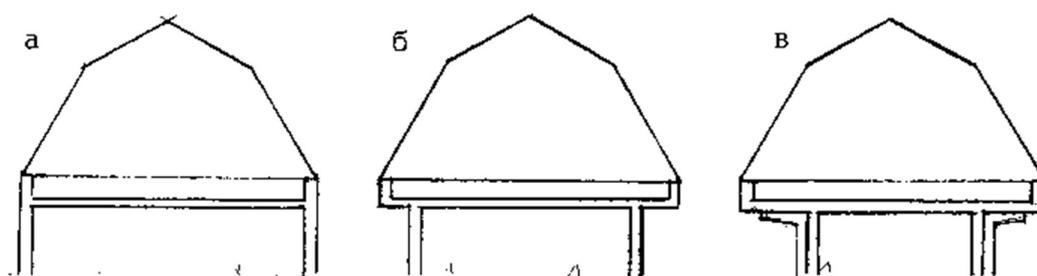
Схемы размещения мансарды: а – в створе наружных стен здания; б – с выходом за границы наружных стен на консолях перекрытия; в – то же, на дополнительных наружных опорах
